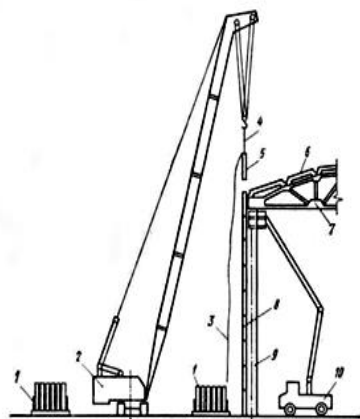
Схема монтажа стеновых ограждающих панелей, кран расположен между двумя кассетами: 1 – кассета для складирования панелей стен; 2 – монтажный кран; 3 – оттяжка из пенькового каната; 4 – двухветвевой строп; 5 – панель стены; 6 – смонтированное покрытие; 7 – стропильная ферма; 8 – стеновое ограждение; 9 – колонна; 10 – монтажный гидроподъемник на автомобиле
